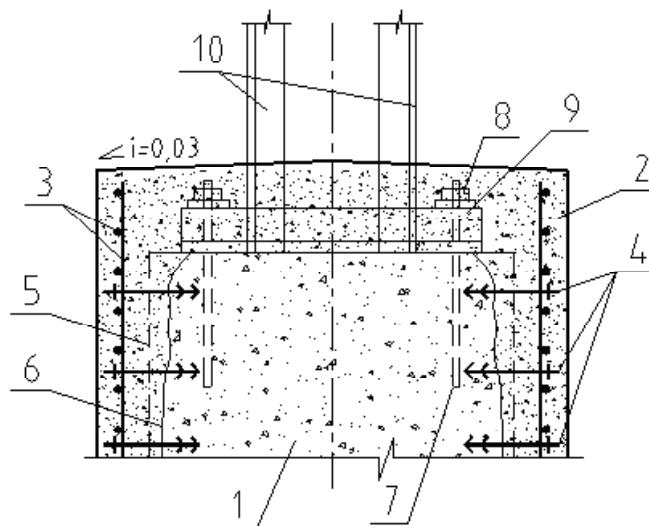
Усиление фундамента выполнением монолитной железобетонной "рубашки": 1 – существующая конструкция фундамента; 2 – восстанавливающий слой бетона; 3 – арматурные сетки; 4 – анкера; 5 – контур бывшего фундамента; 6 – поверхность разрушенного фундамента; 7 – существующие анкера; 8 – гайки с шайбами; 9 – существующая база опоры; 10 – стойка.
